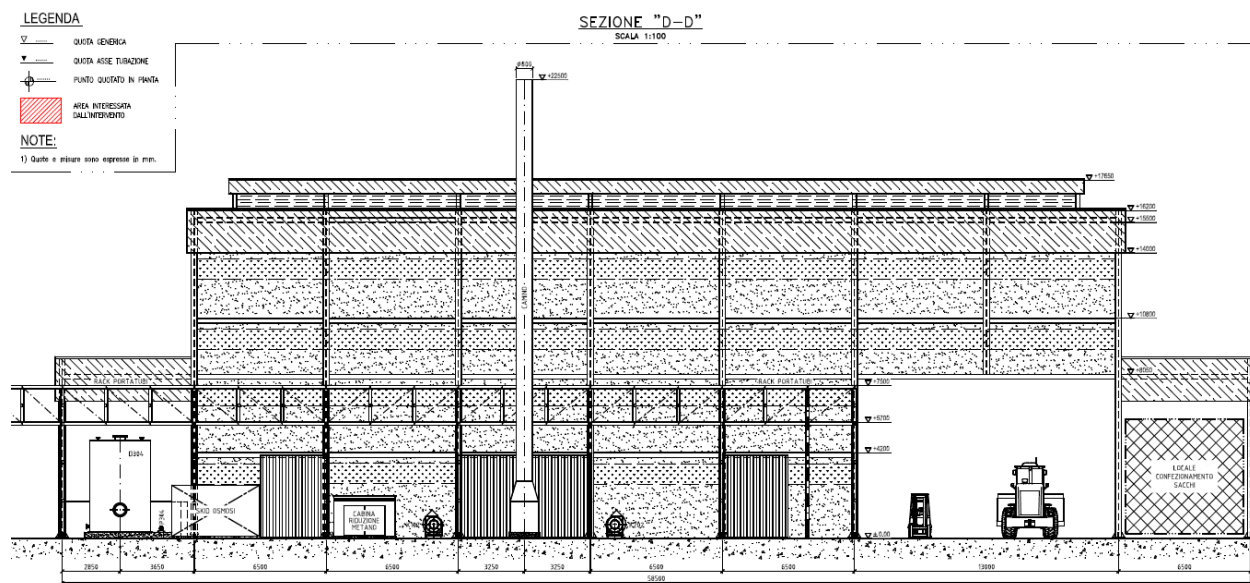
Progetto definitivo delle opere (sezione "D-D")
